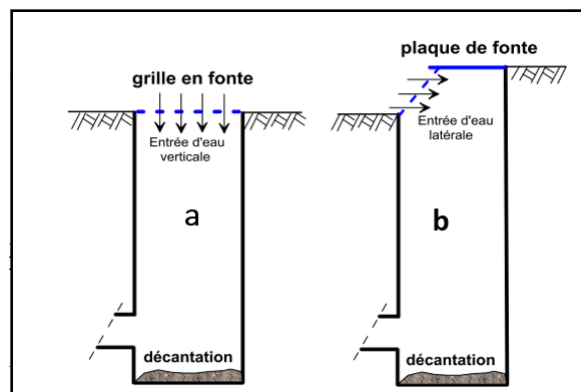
a) Avaloir sous la chaussée b) avoir sous trottoir [5]
